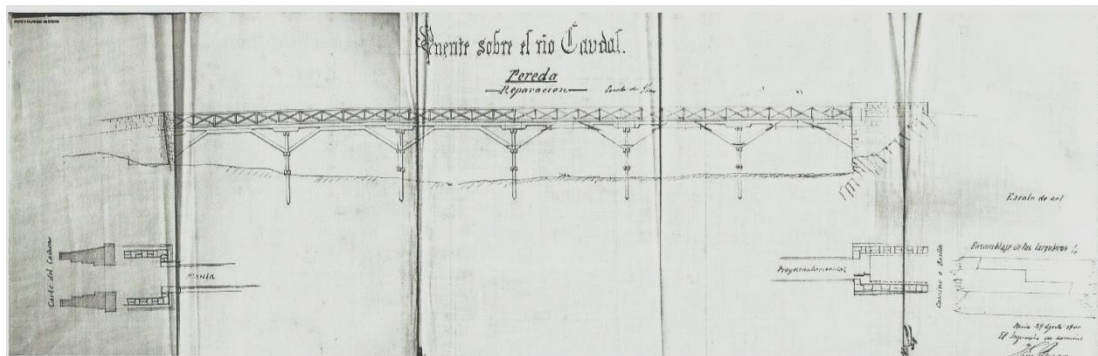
Proyecto de reparación del puente de La Pereda. Plano. 1900. Archivo Municipal de Mieres
